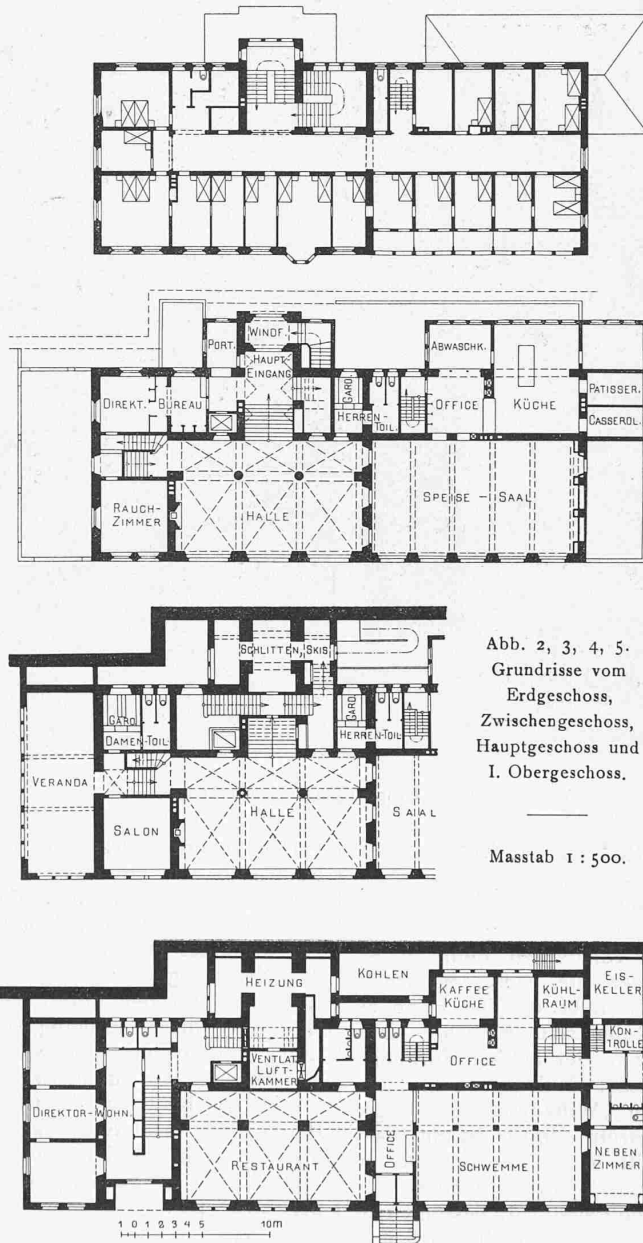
, 3, 4, 5. Grundrisse vom Erdgeschoss, Zwischengeschoss, Hauptgeschoss und I. Obergeschoss.
